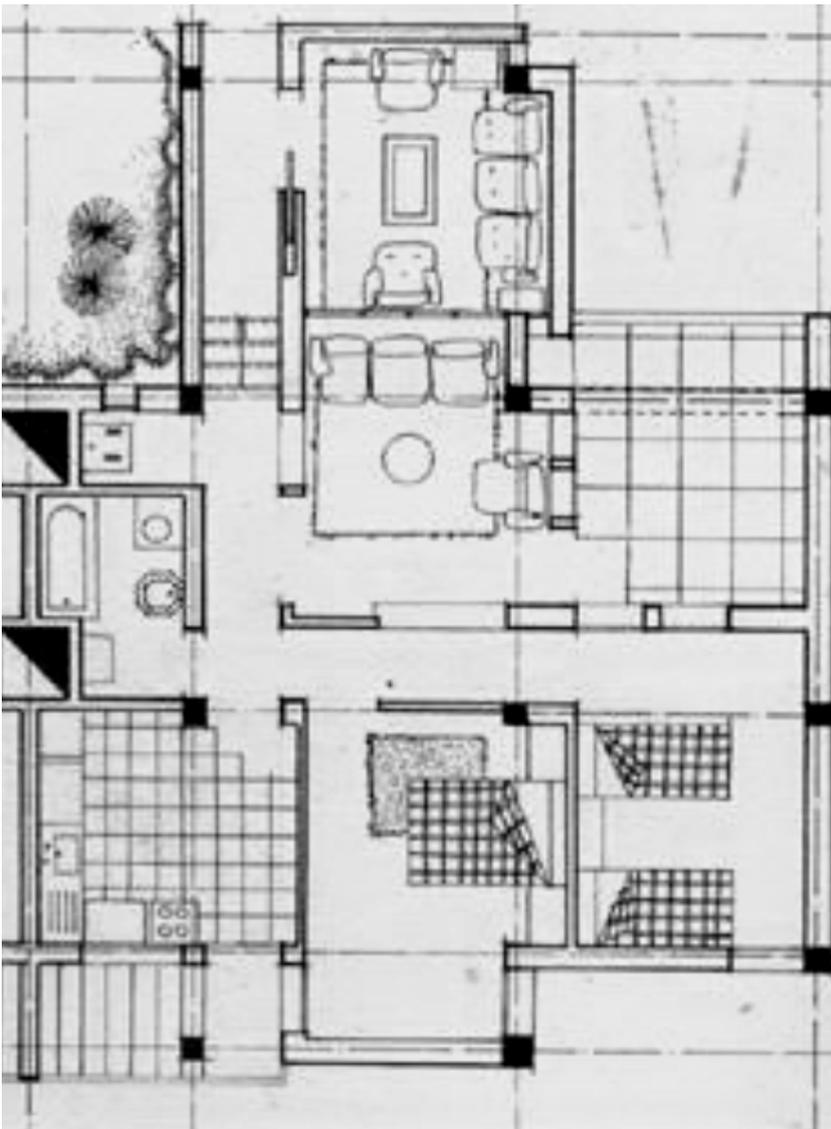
Planta detallada de la vivienda F3 [Dibujo]
